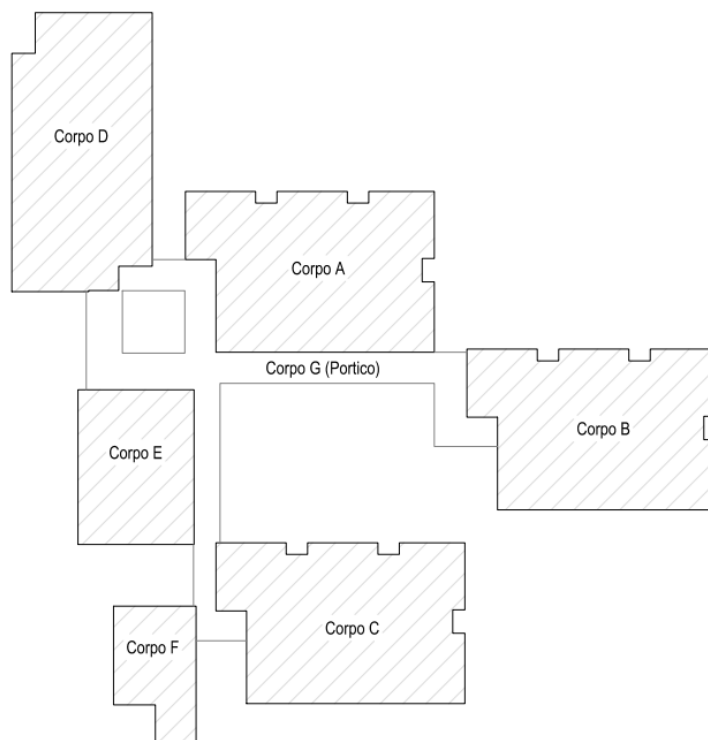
schema planimetrico con identificazione dei corpi strutturali
